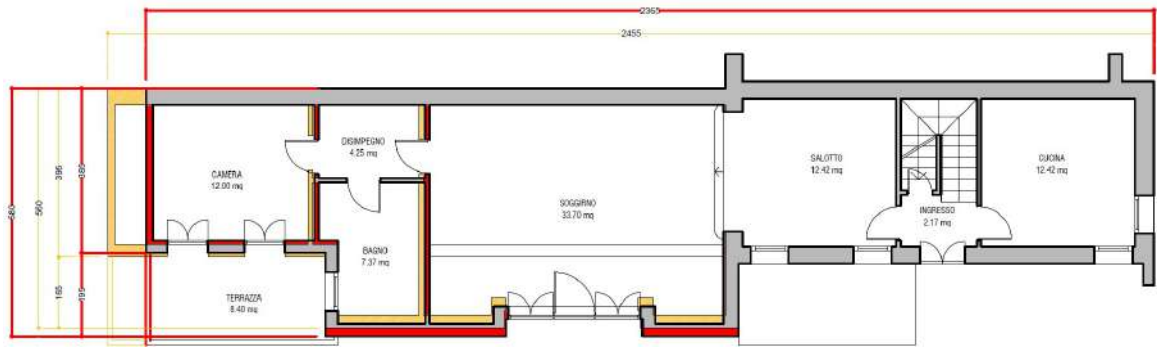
Planimetria P.lla 953 sub. 1 e P.lla 189 abitazione P.T. – difformità
